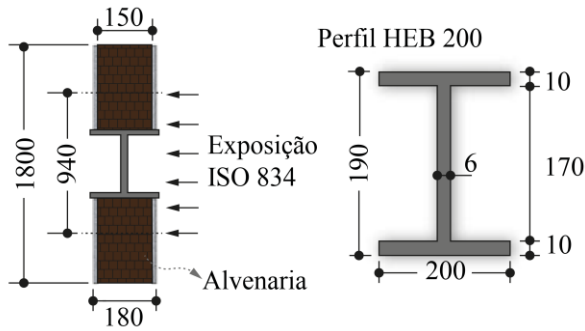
Modelo estrutural e dimensões (em mm) do perfil I
